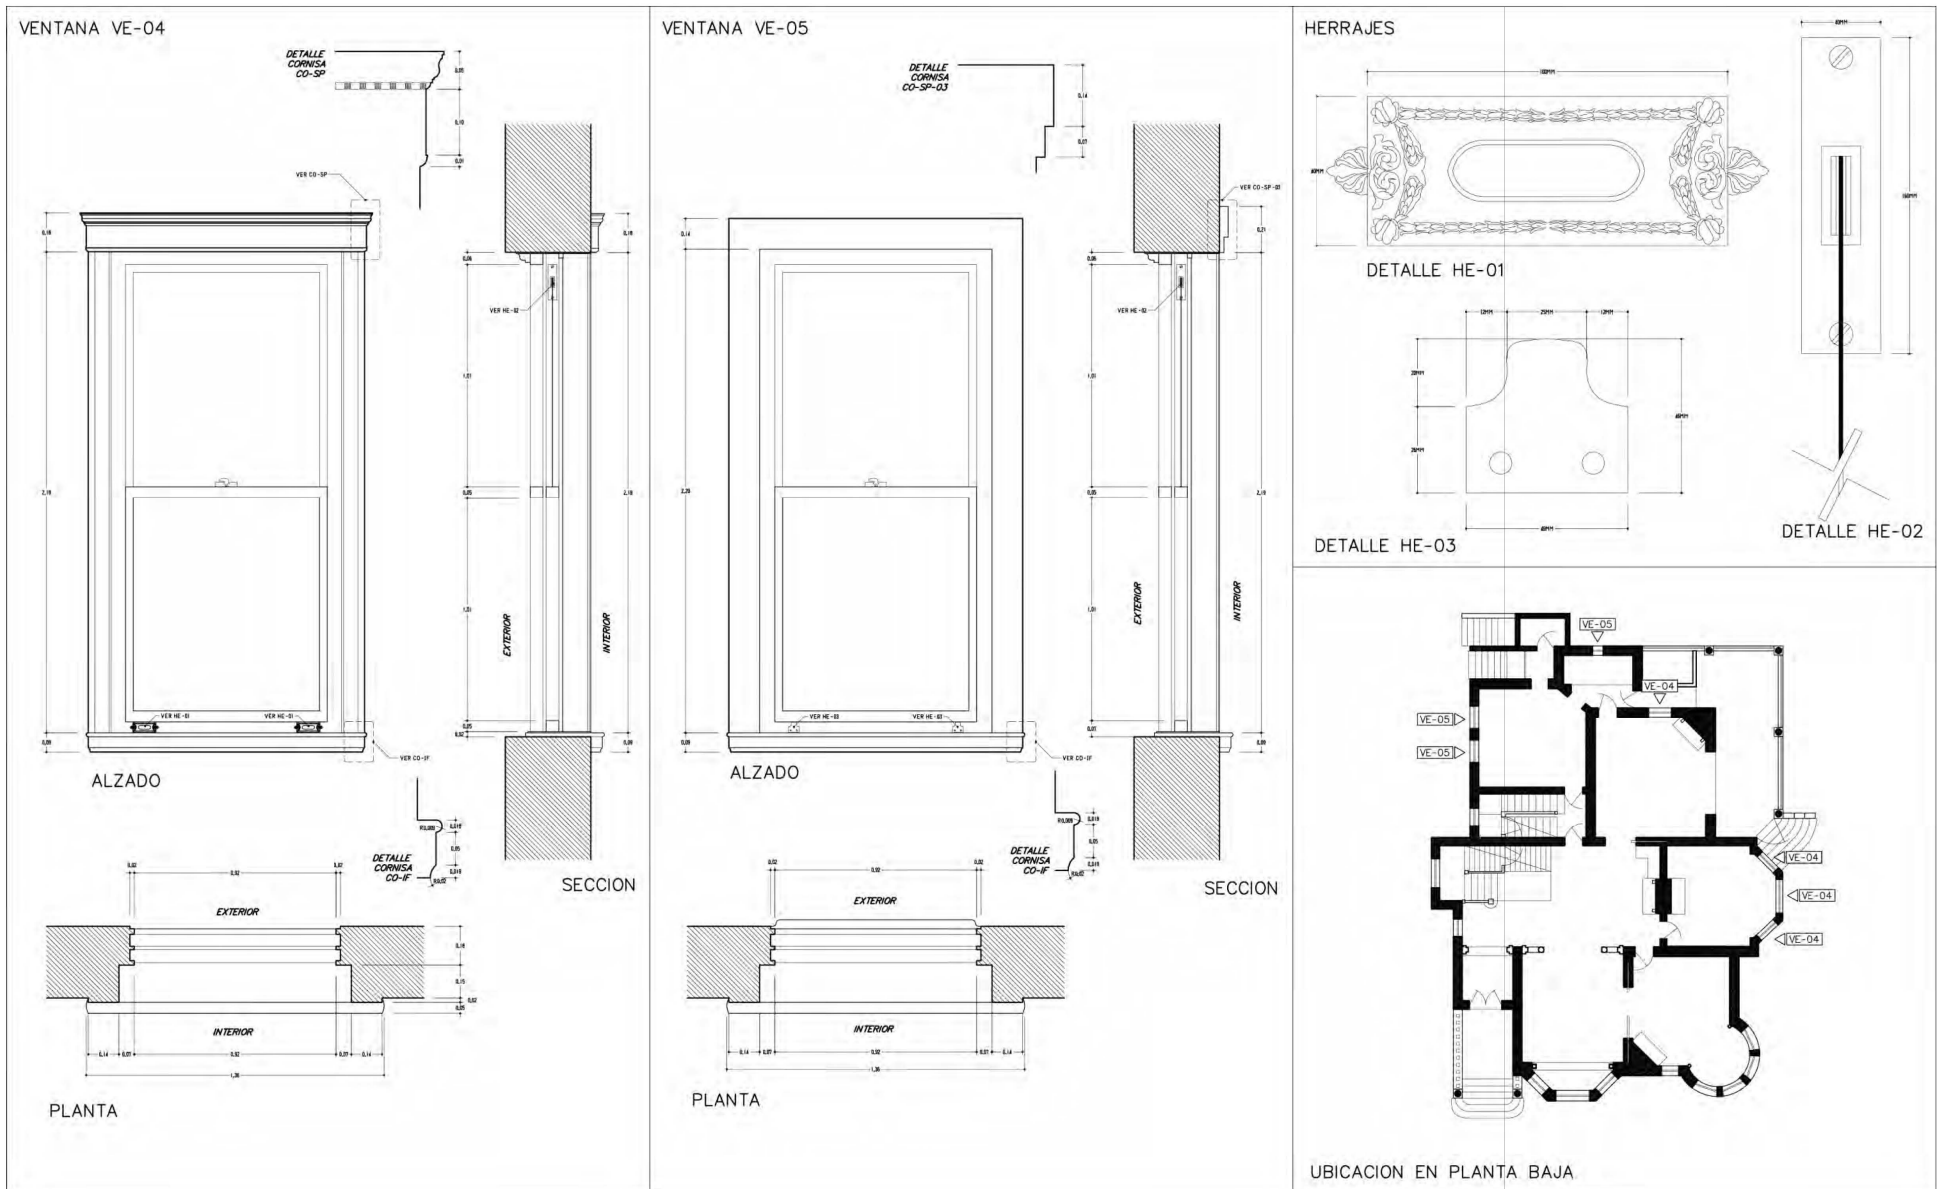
Plano de carpinterías 01 de General Gómez Pedraza 72. Elaboración propia. Fuente: Levantamiento en sitio. Fecha: noviembre 2017.
